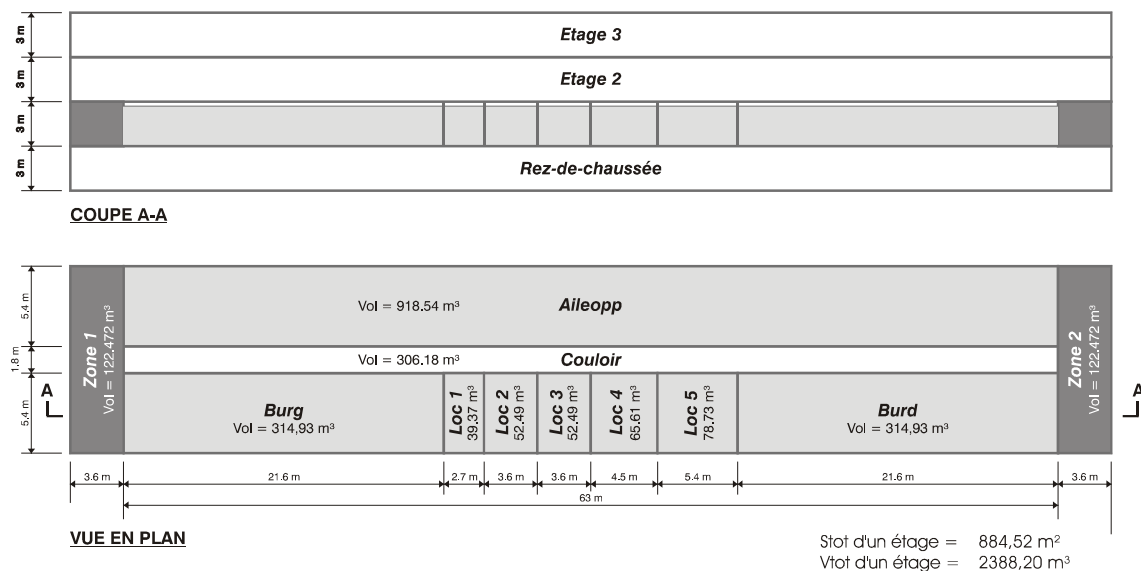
Vue en coupe et en plan du bâtiment modélisé
